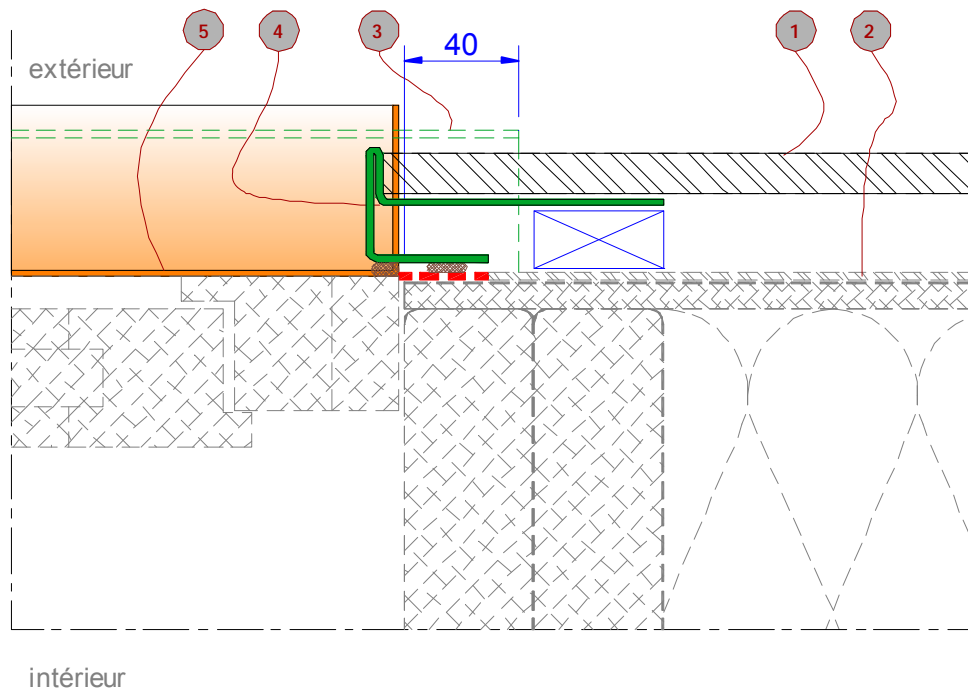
Pose sur COB – Coupe sur linteau de baie
